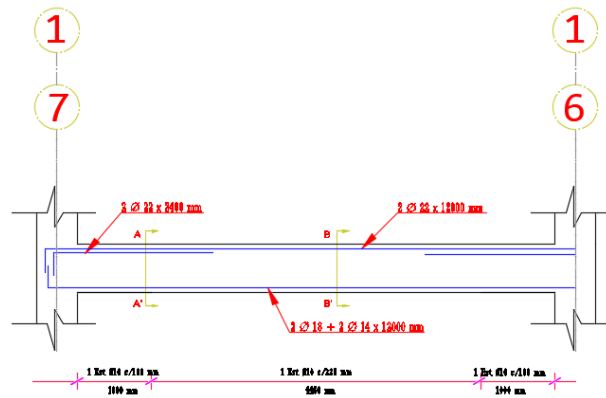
Detalle de viga principal eje "Y" piso 4.
